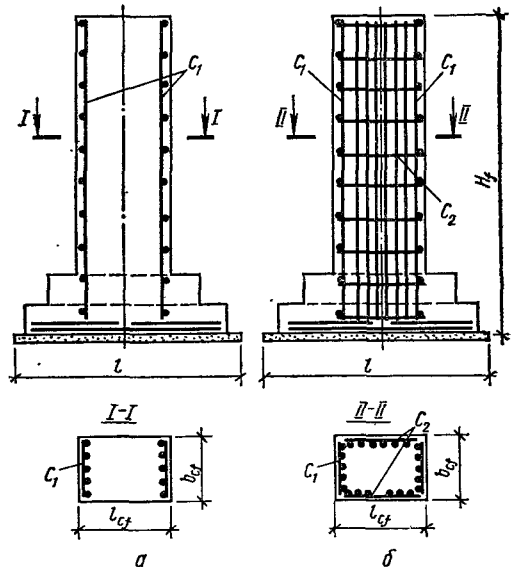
Армирование подколонников прямоугольного сечения сварными сетками без их связи хомутами и шпильками:
